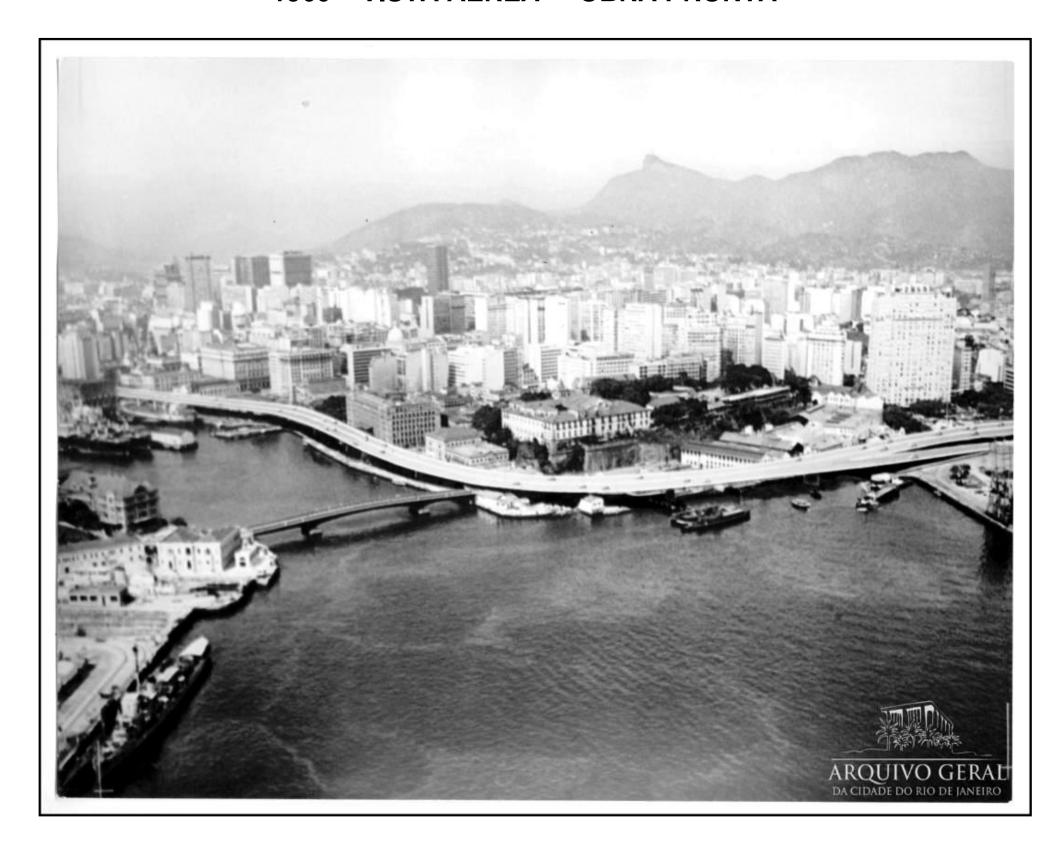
FOTO DO ELEVADO DA AV. PERIMETRAL EM CONSTRUÇÃO
